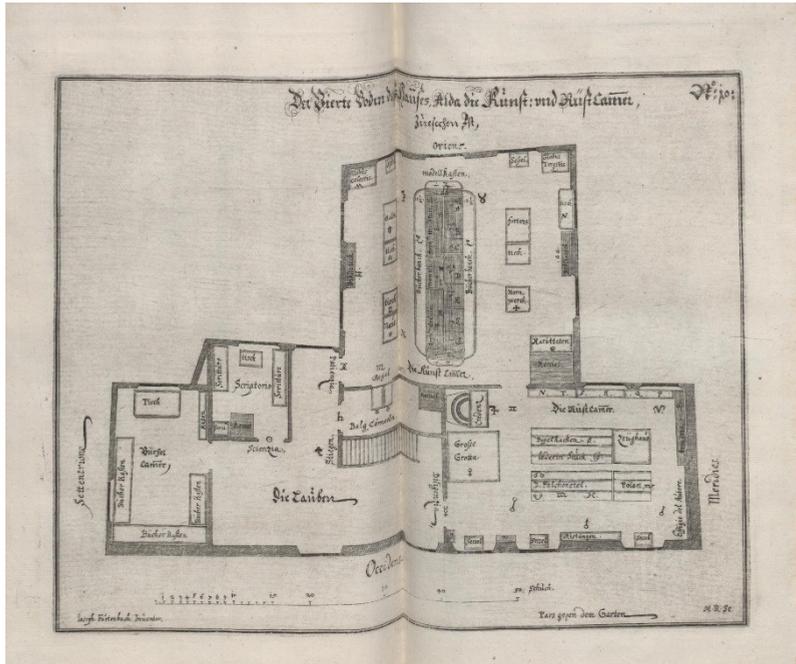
Joseph Furtenbach d.Ä., *Architectura Privata, Grundriss der Kunst- und Rüstkammer im Wohnhaus der Furtenbachs*, Kupferstich, 1641
